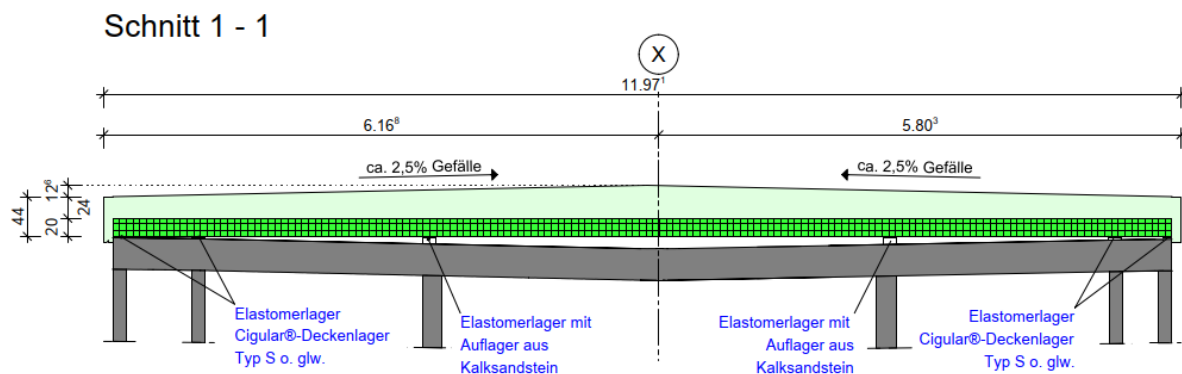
Schnitt durch den Tropfkörper nach der Umbaumaßnahme; in grün neue Stahlbetonplatte, in hellgrün unbewehrter Aufbeton zur Auftriebssicherung
